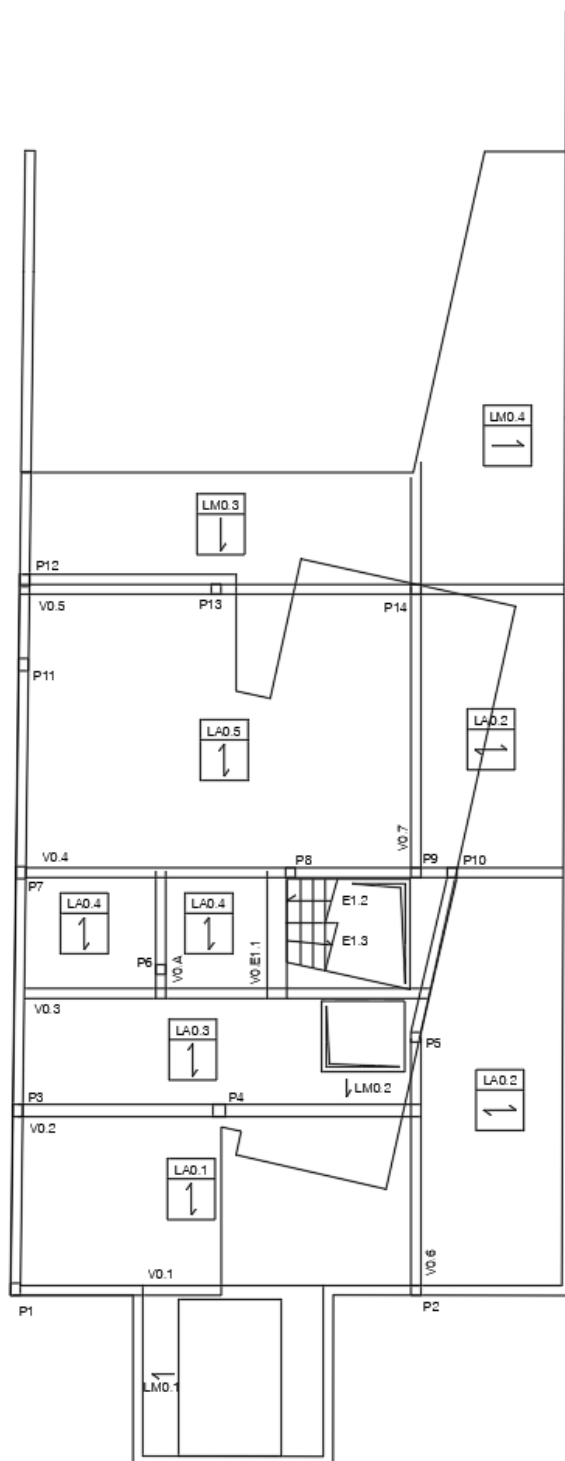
Esquema estrutural do R/C (Projeto de estruturas).
